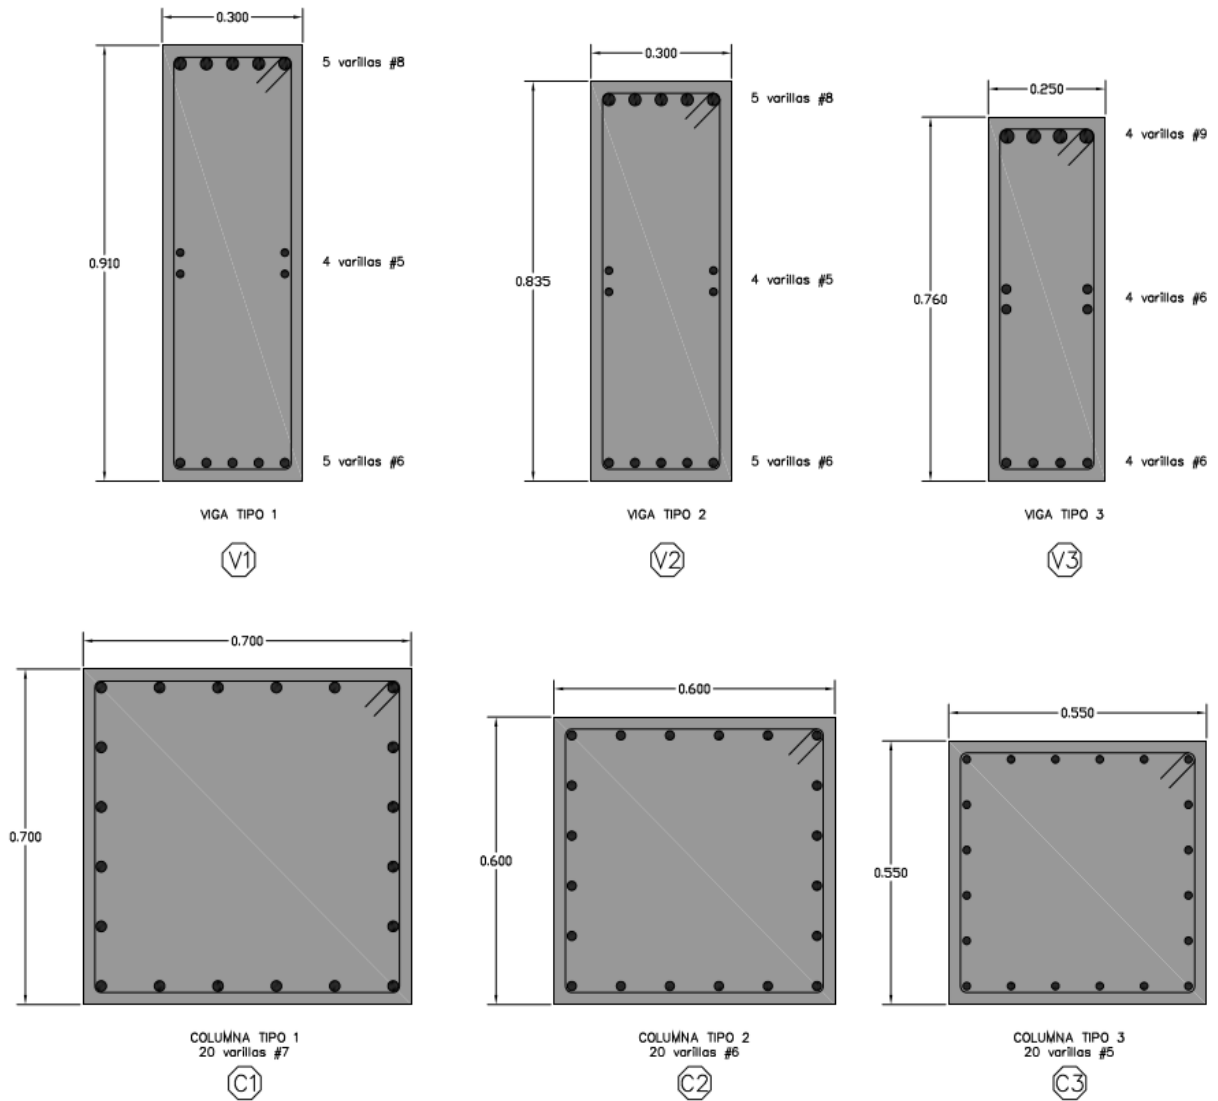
Detalles constructivos para el edificio de 12 niveles
